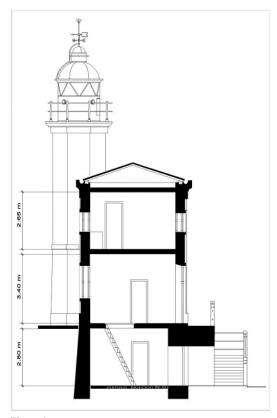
Sección N-S del faro de Zumaia (Llano, U.).
